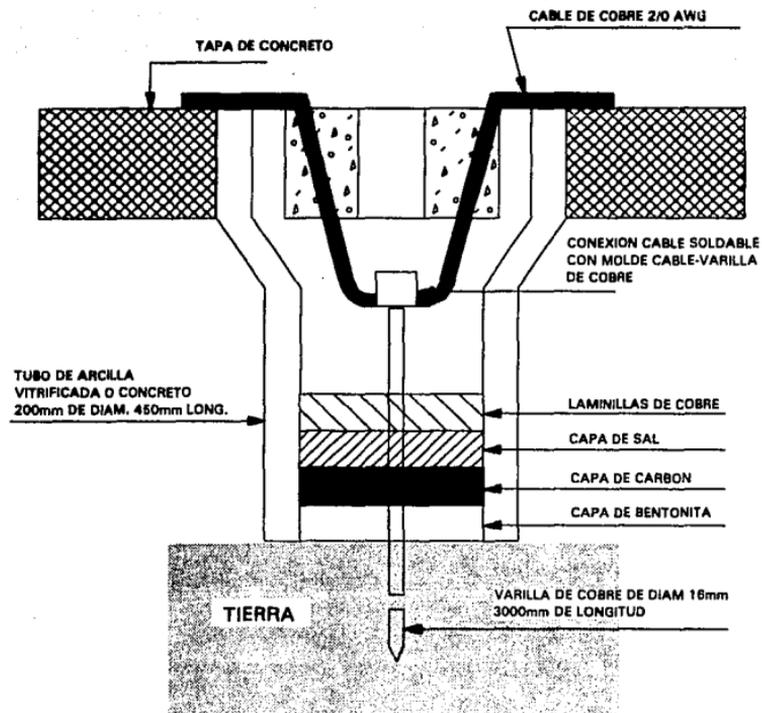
DETALLE DE LOS POZOS DE ATERRIZAJE
